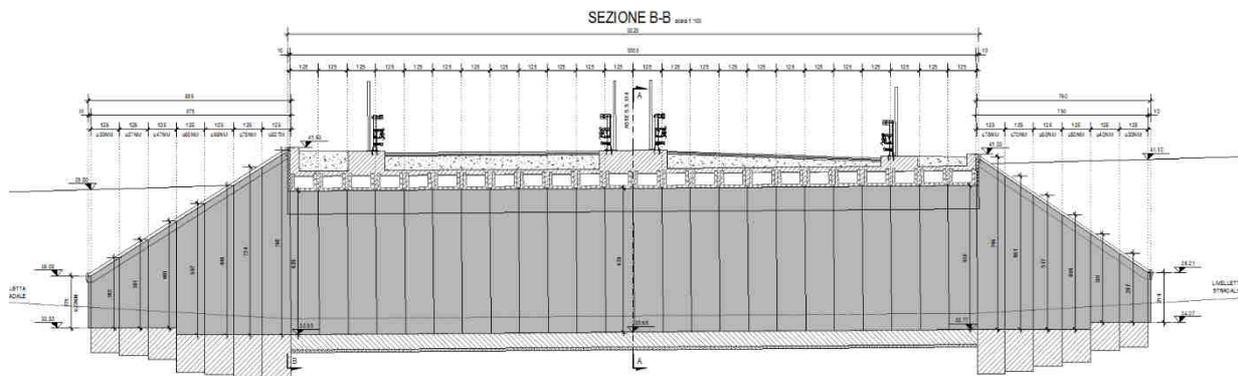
Prospetto longitudinale con muri di imbocco - Sottovia km. 11+500
